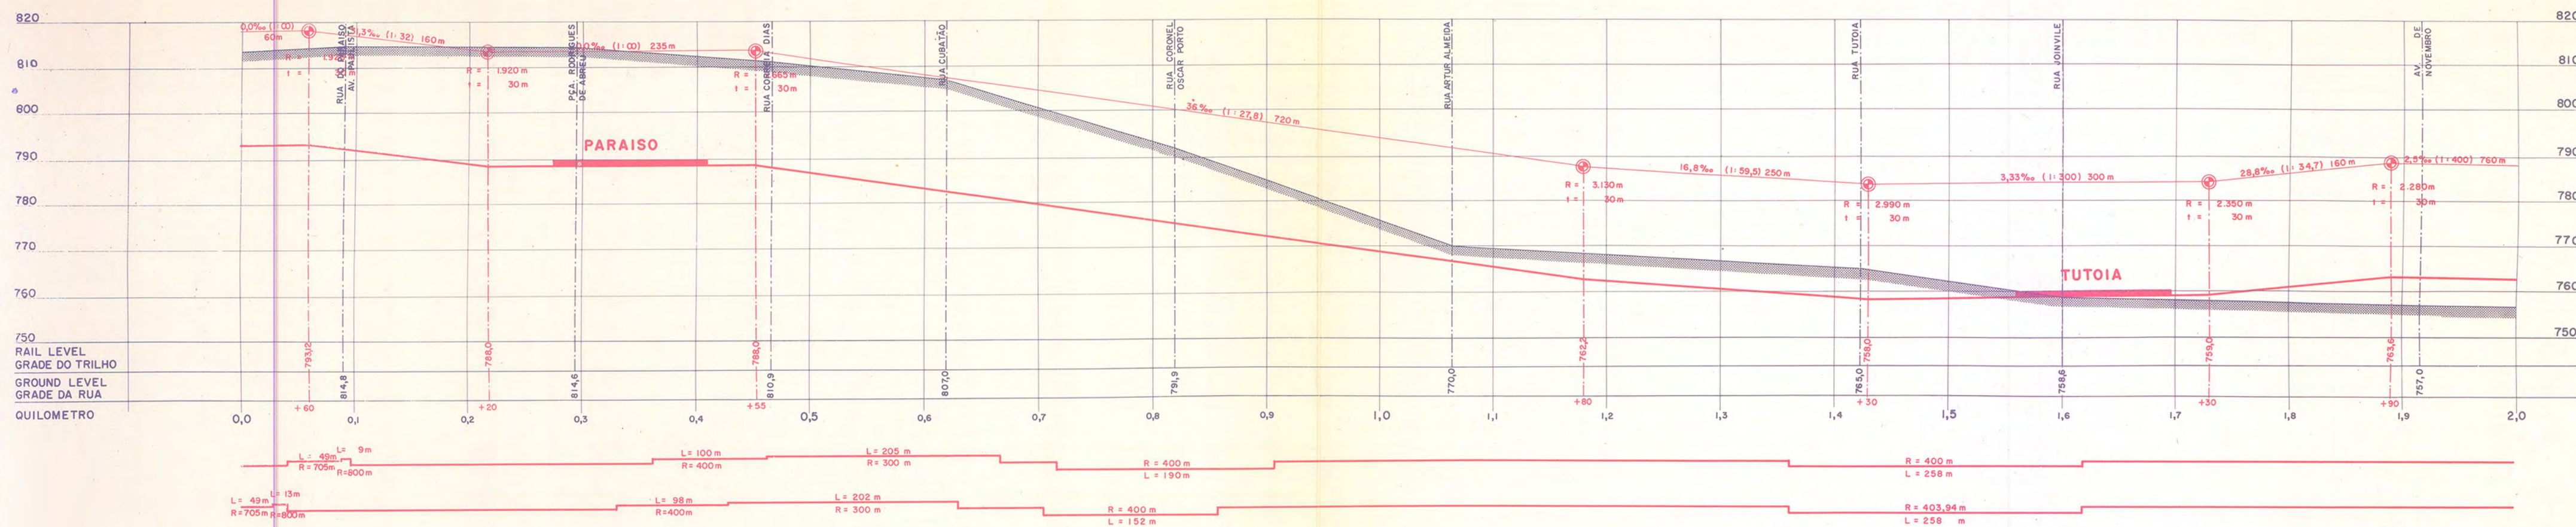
/VI Traçado da Linha Santana-Jabaquara, com ramal Paraiso-Moema; perfil longitudinal e planta
